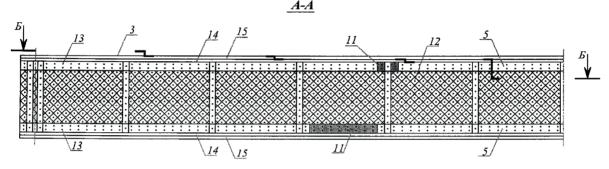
Фасад дощато-брусчато-нагельно-гвоздевого блока, вид по А-А на рис. 1
